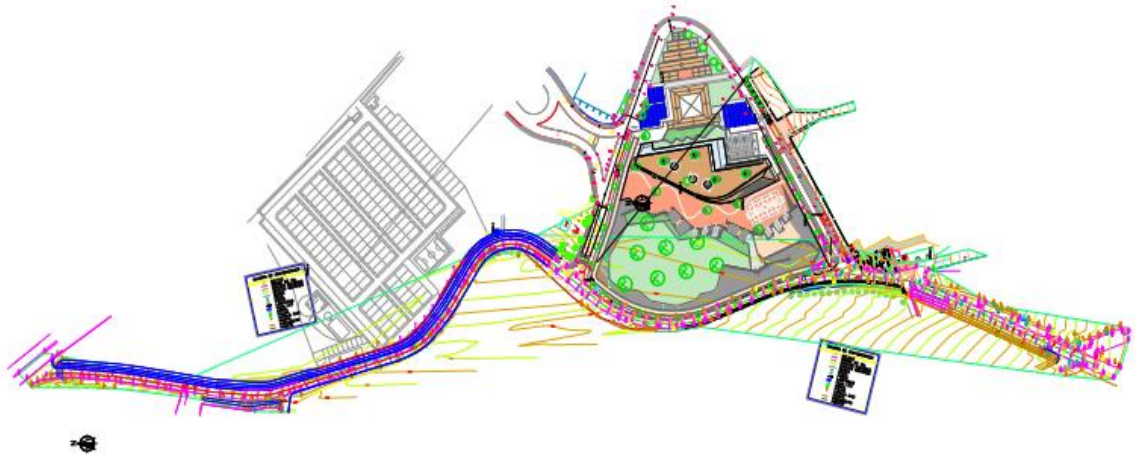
Plano urbanístico con parque, Arquitecto Libardo Mejía.
